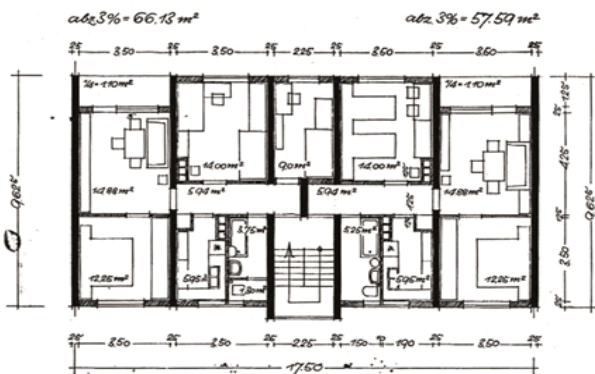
План типового поверху 1:200 Мюнхен, Головне управління будівельного нагляду 1953
